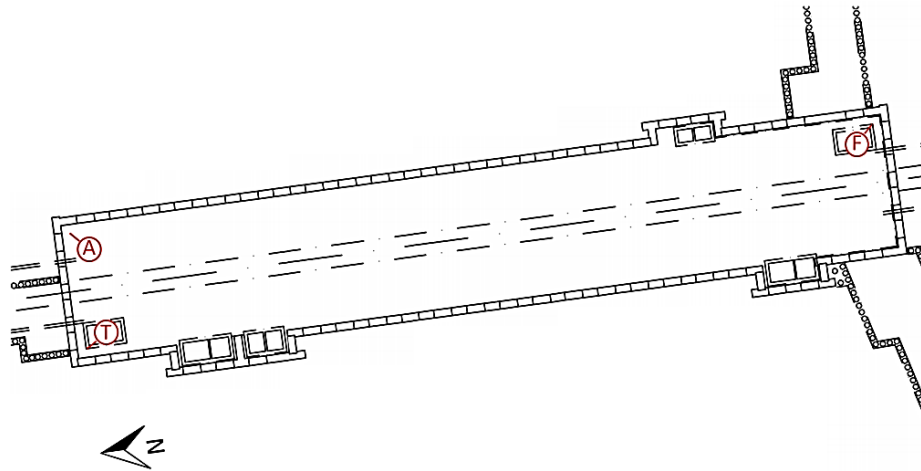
Planta da estação de metro *Pôle Universitaire
